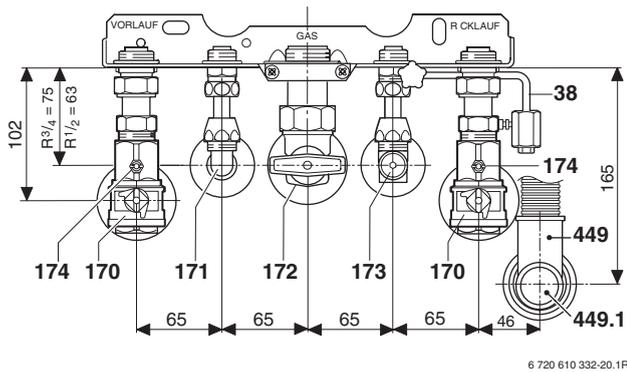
Montageanschlussplatte mit Unterputz-Installation (fertig montiert)
